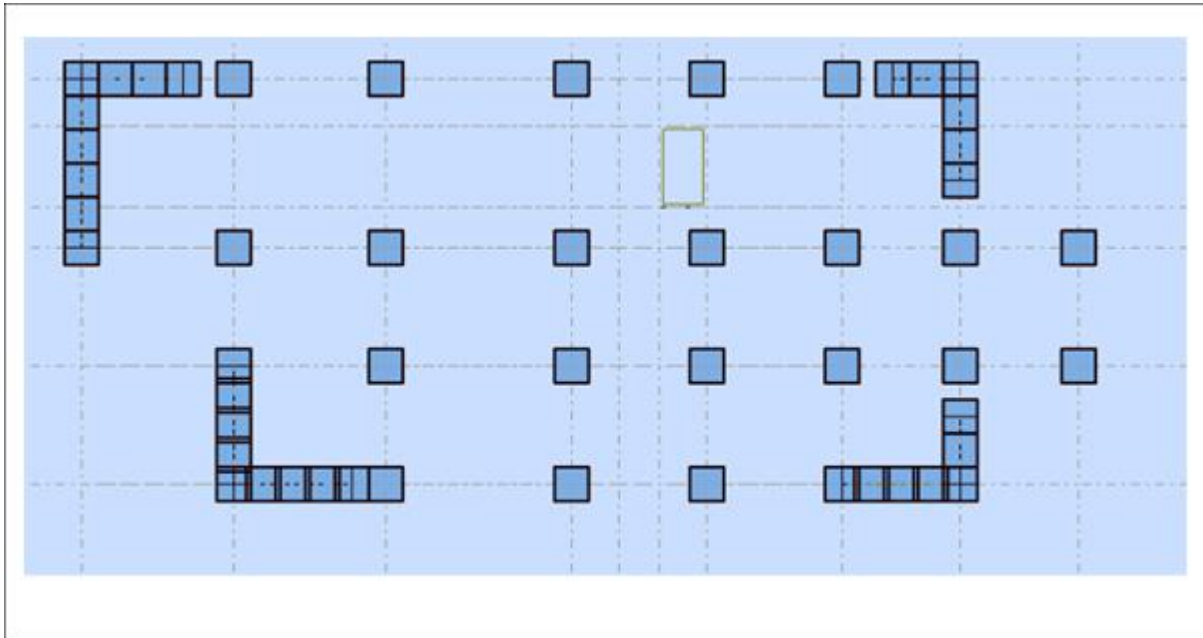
Vue en 2D et plan de la 1ère proposition.
